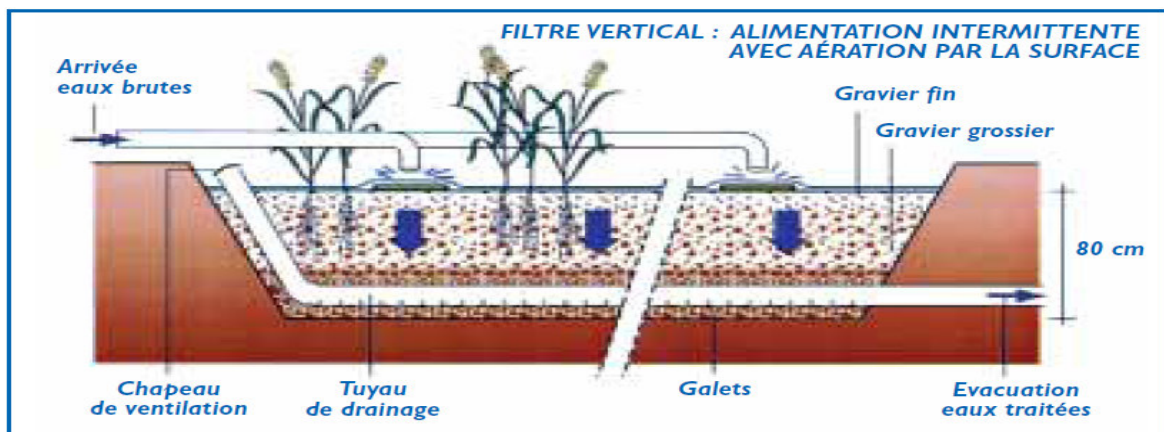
Coupe transversale d'un filtre planté à écoulement vertical.
